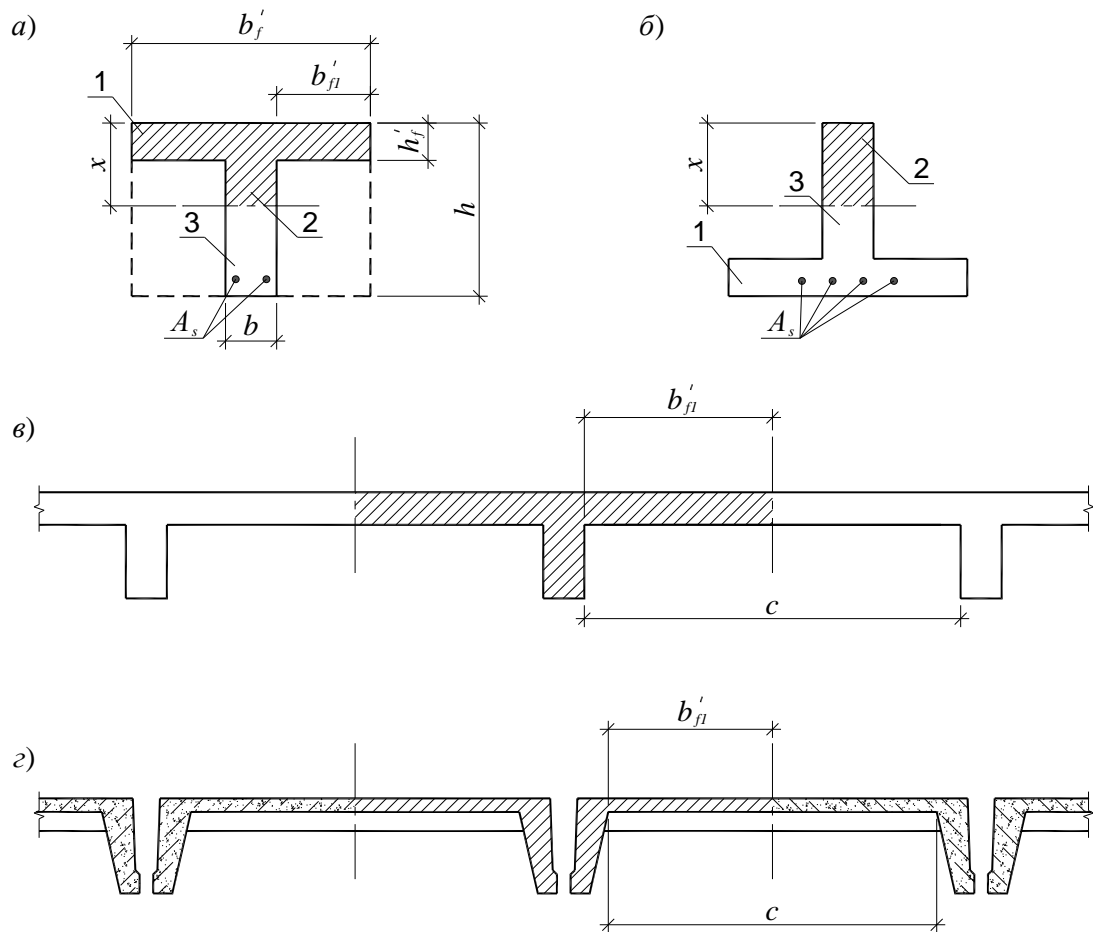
Тавровые сечения: *а* – балка с полкой в сжатой зоне; *б* – то же в растянутой зоне; *в* – тавровое сечение в составе монолитного перекрытия; *г* – то же в составе сборного перекрытия; 1 – полка; 2 – сжатая зона; 3 – ребро.
